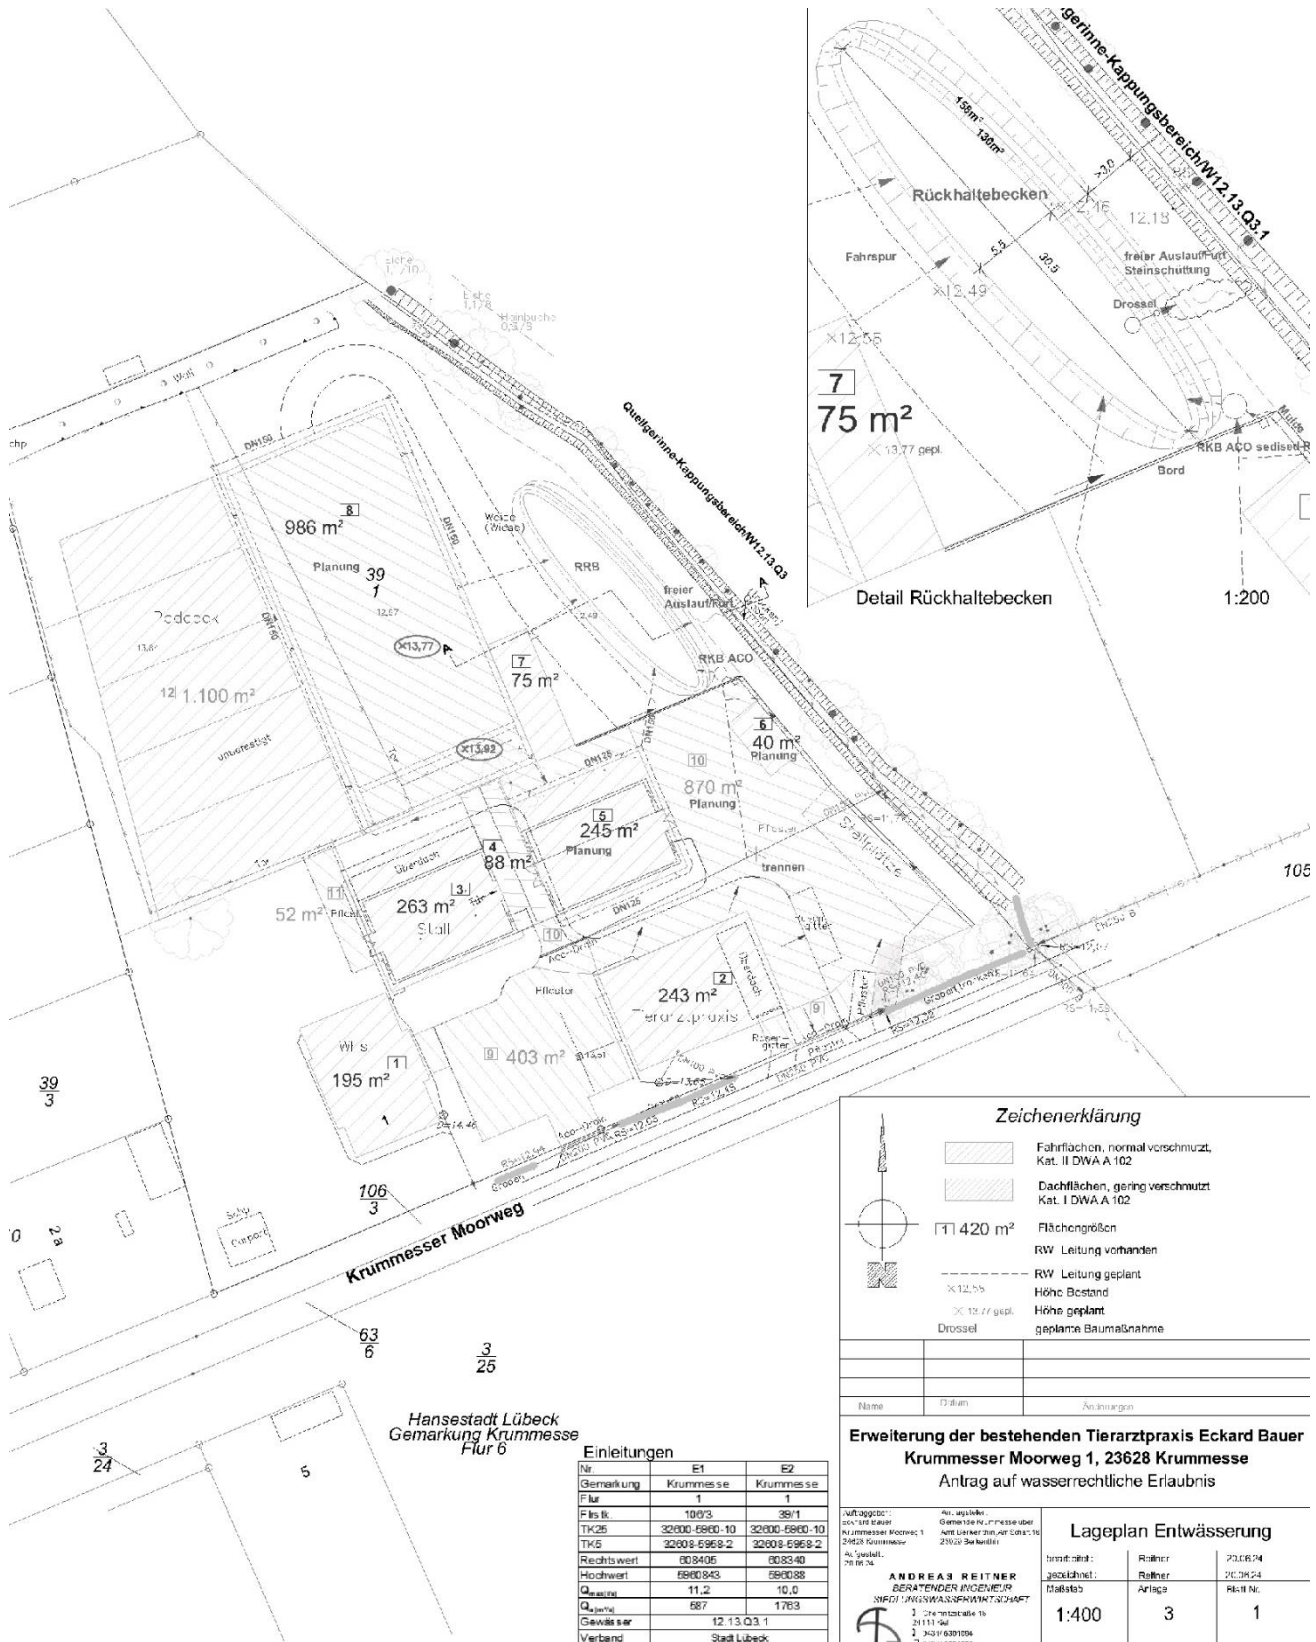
Lageplan zur Entwässerung einschließlich RRB (Ingenieurbüro A. Reitner, Beratender Ingenieur)
